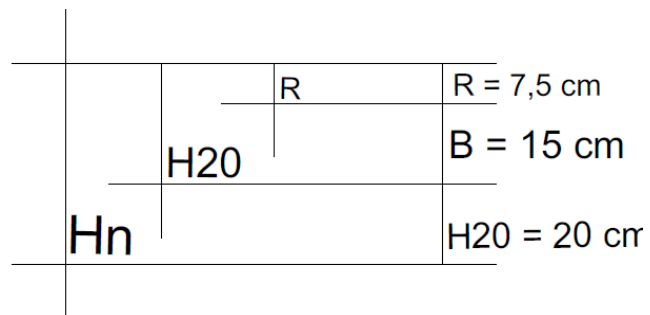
Detalhamento da distribuição das camadas que compõe o pavimento
